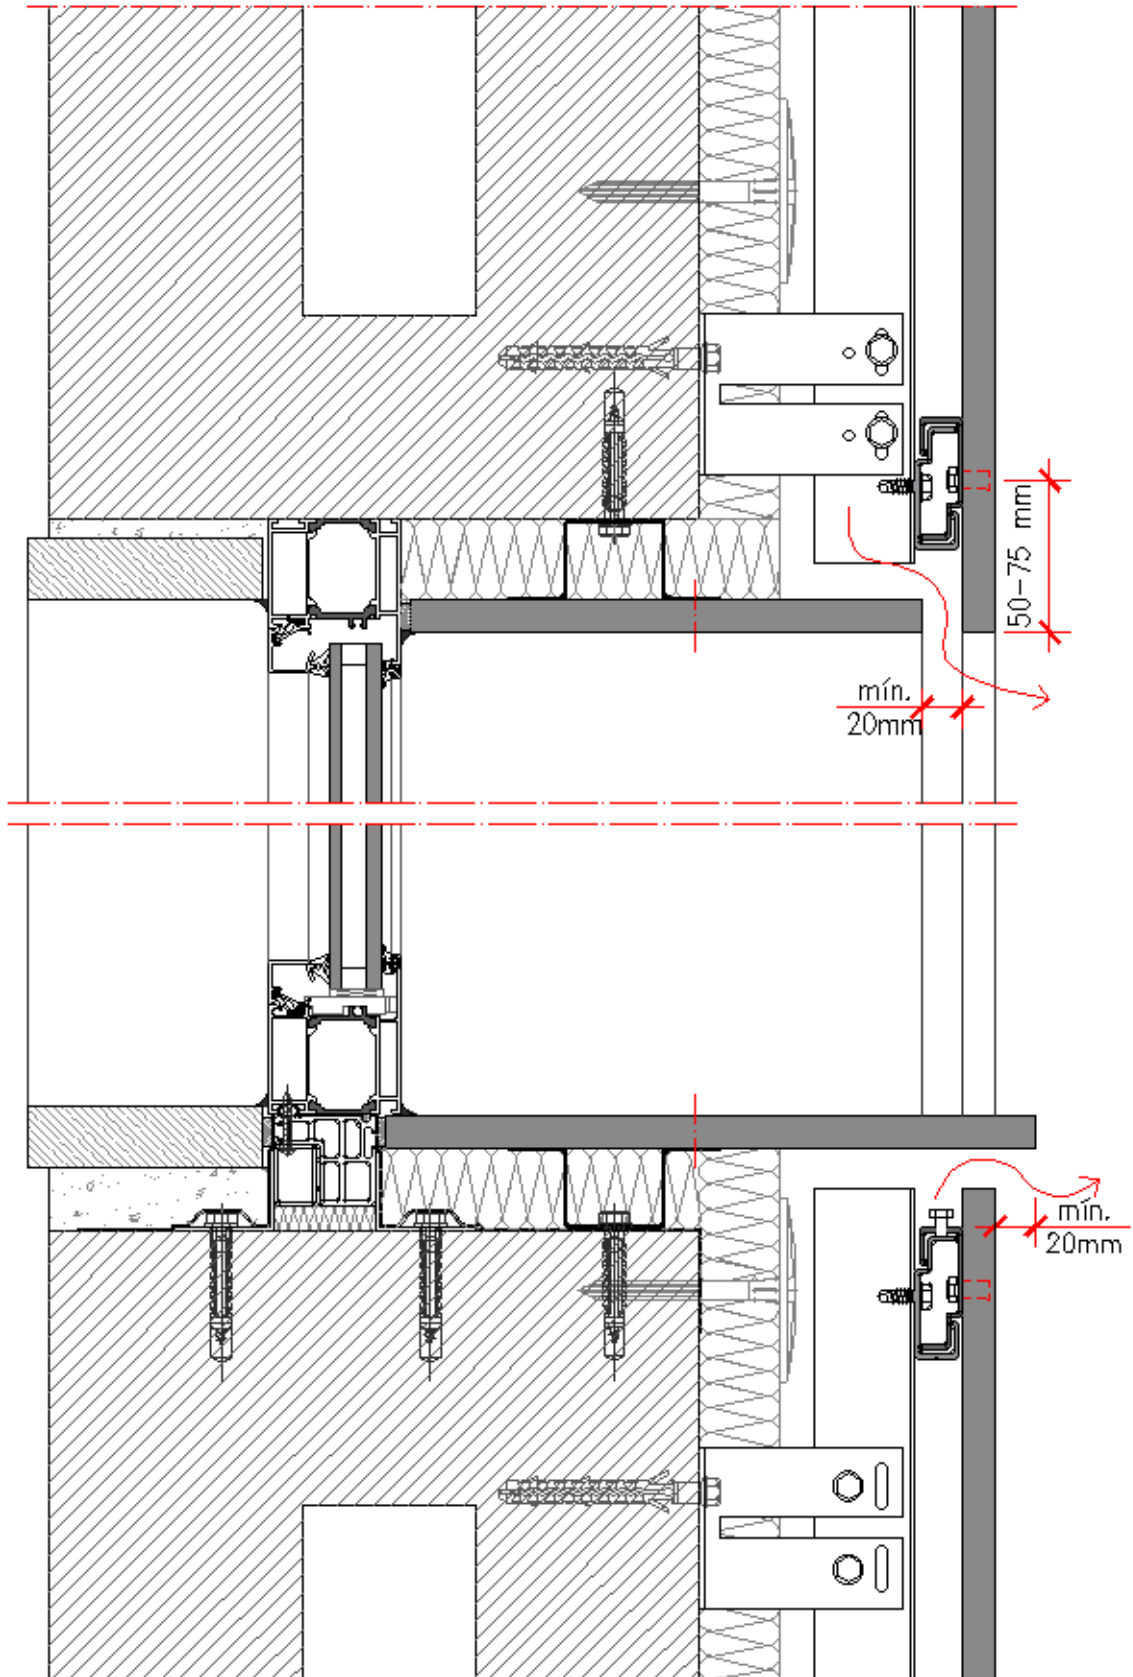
Détail d'une portée de fenêtre, coupe verticale
